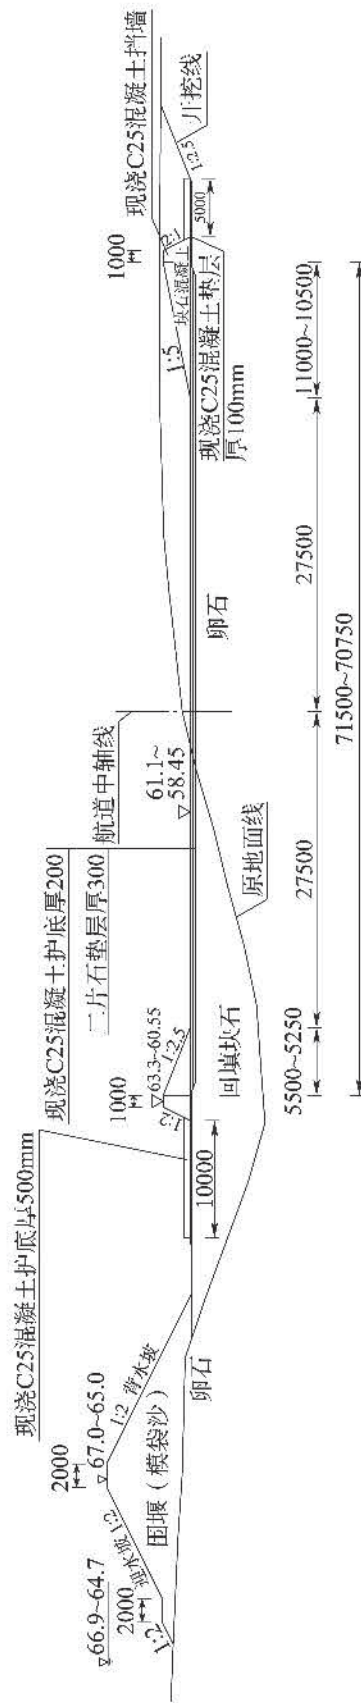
航道整治工程-阿江某航道整治工程-明渠断面示意图(尺寸单位:mm;高程单位:m)
